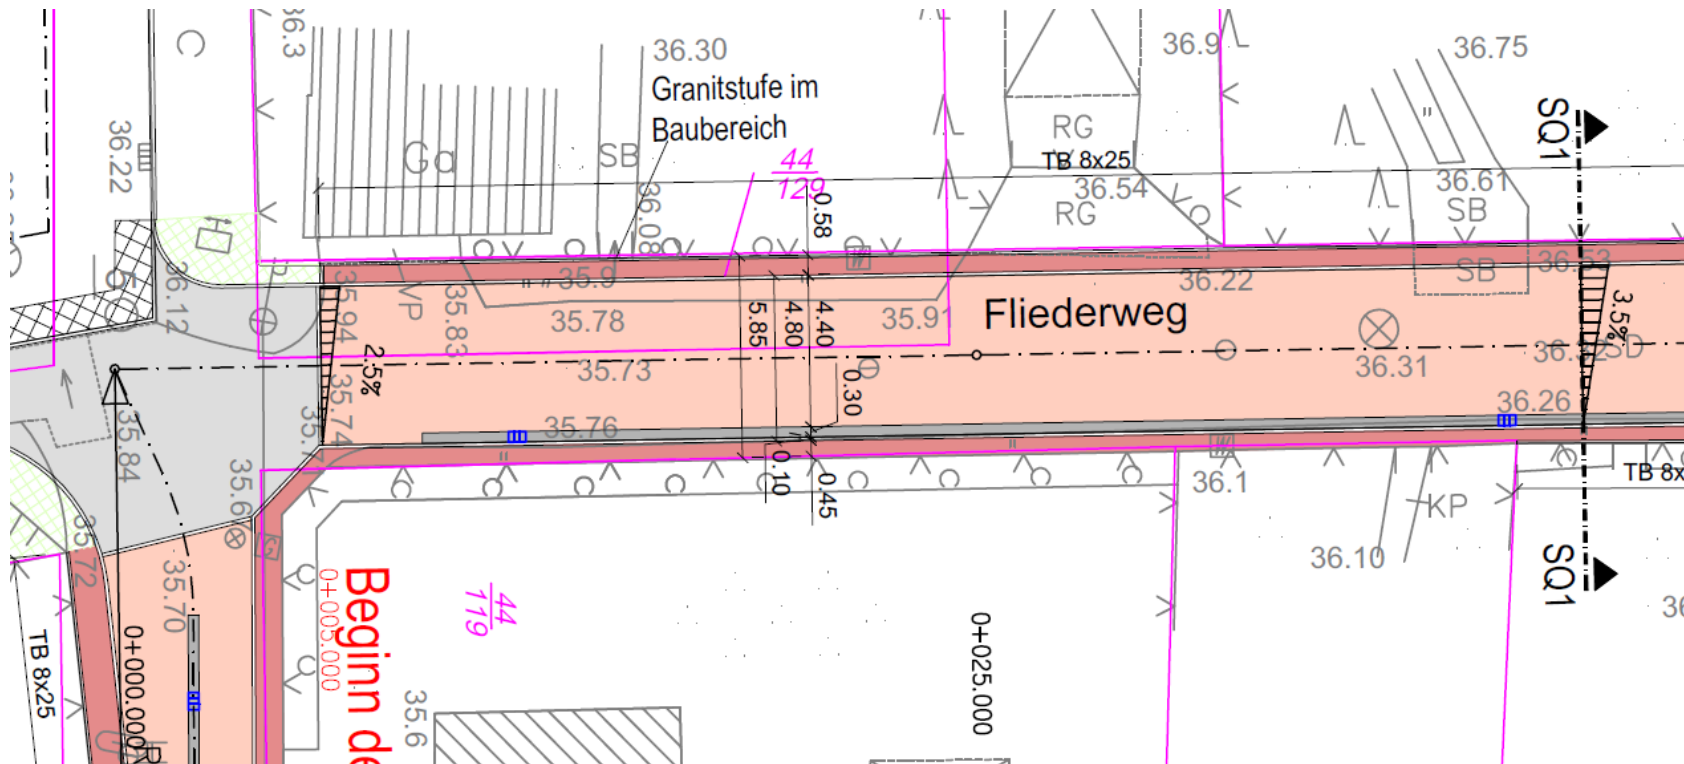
Lageplanausschnitt Vorzugsvariante mit 4,80 m Fahrbahnbreite
